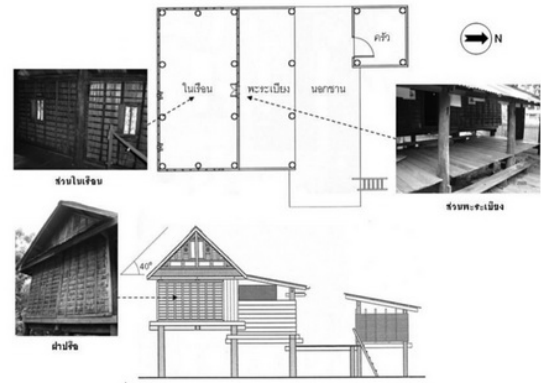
Grundriss und Ansichtszeichnungen des „Huen Korat“
